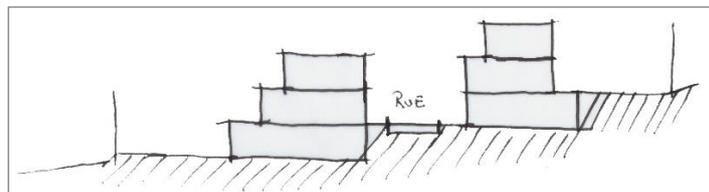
Prinzipschnitt zur Organisation der Baukörper mit Gartengeschossen. Quelle: CO3 2020
